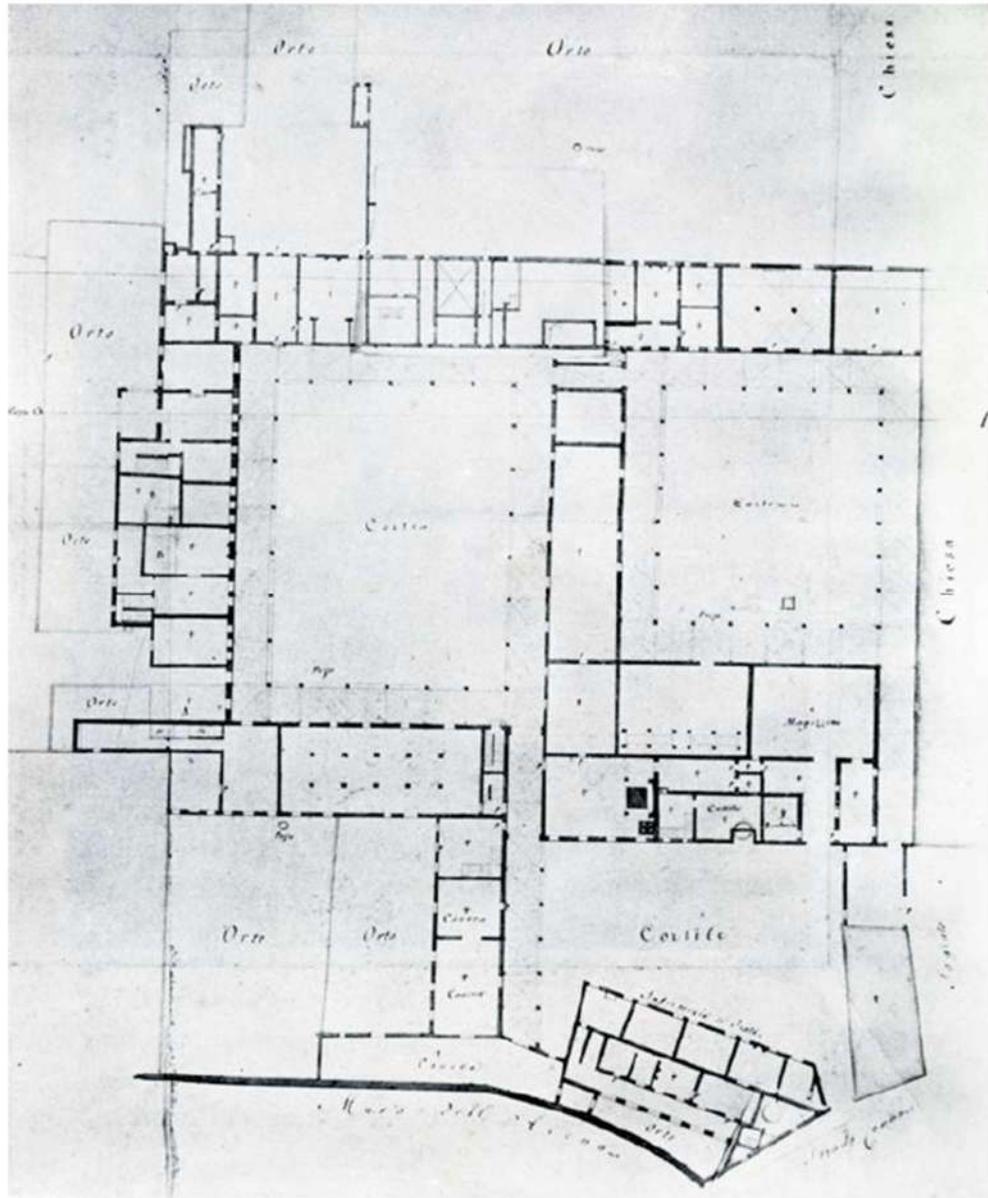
Planimetria convento degli Eremitani di Padova Piano terra, 1803
